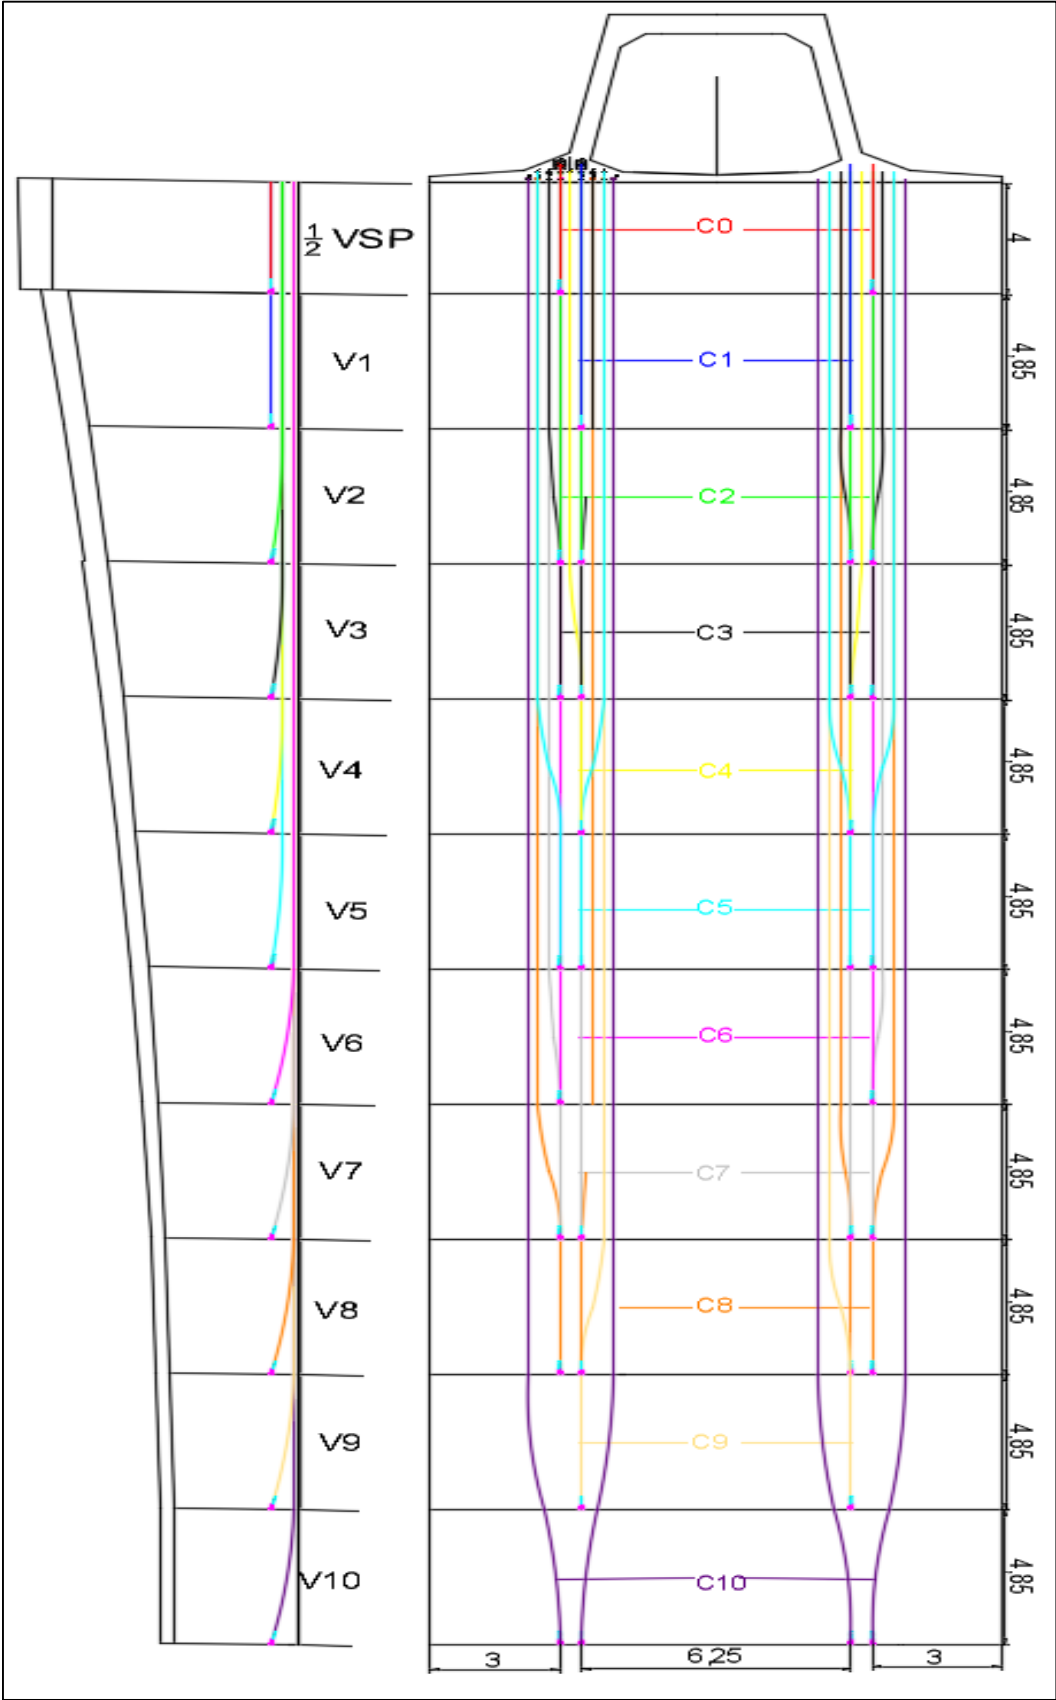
Tracé en élévation et en plan des câbles des fléaux.
